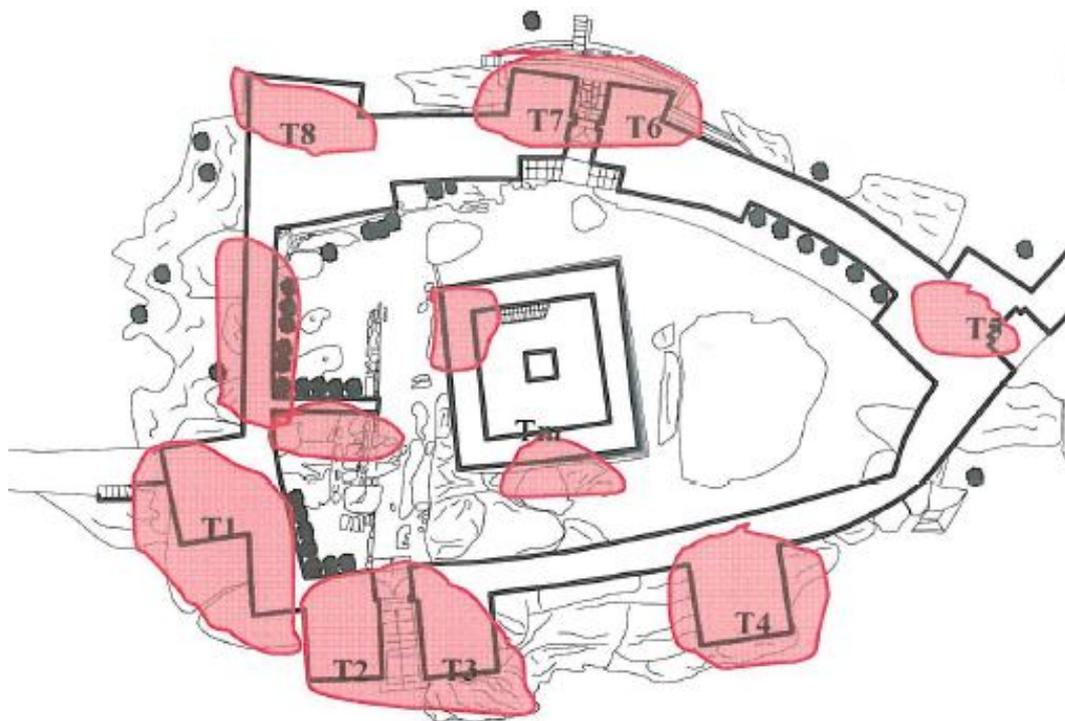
Mapa de danos relativo à fissuração em alvenaria de pedra (F.E.U.P., 2008)
